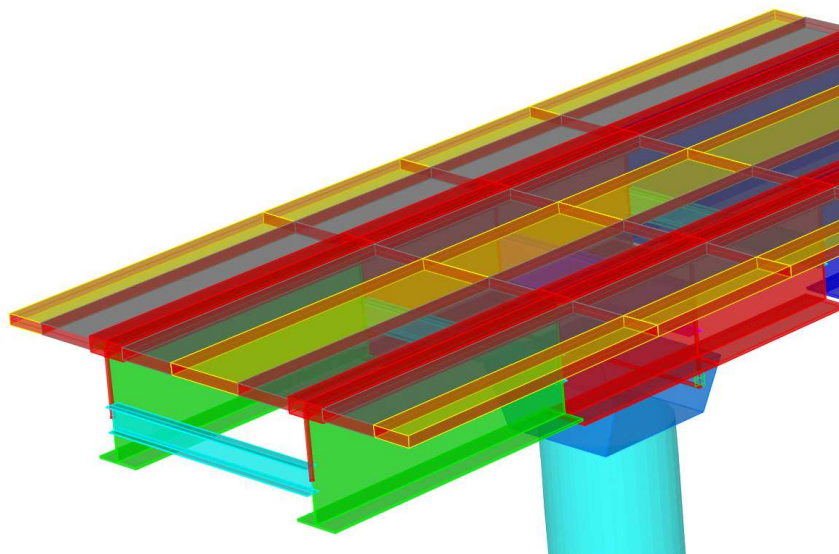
Particolare elementi “shell” con spessore diversi della soletta
